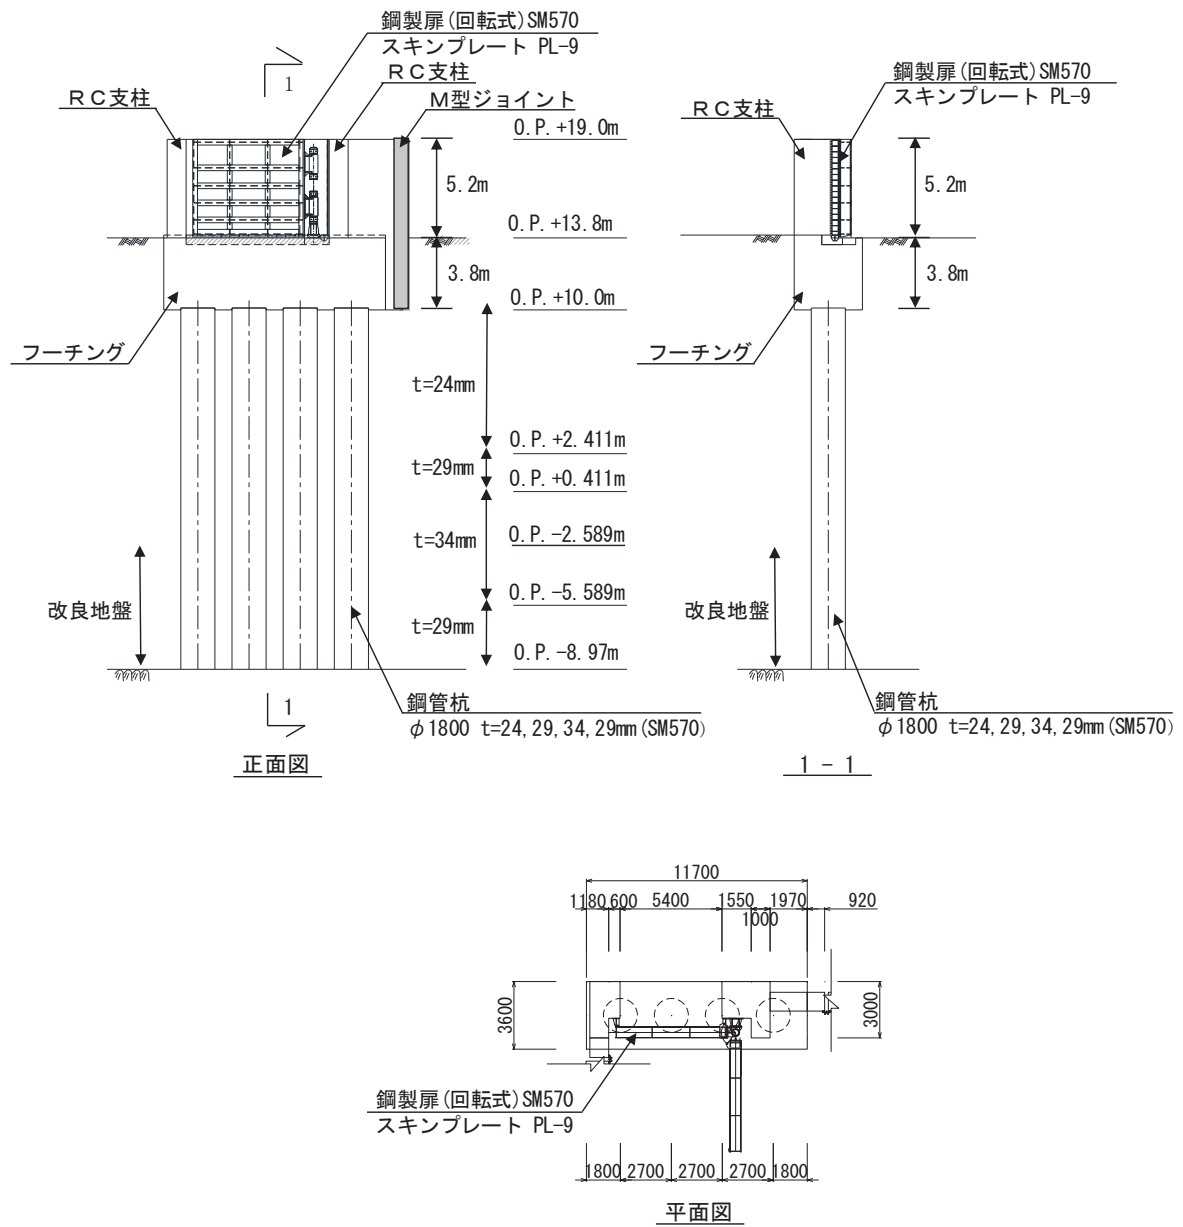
鋼製扉 1 の構造図 (正面図及び断面図, 平面図)
